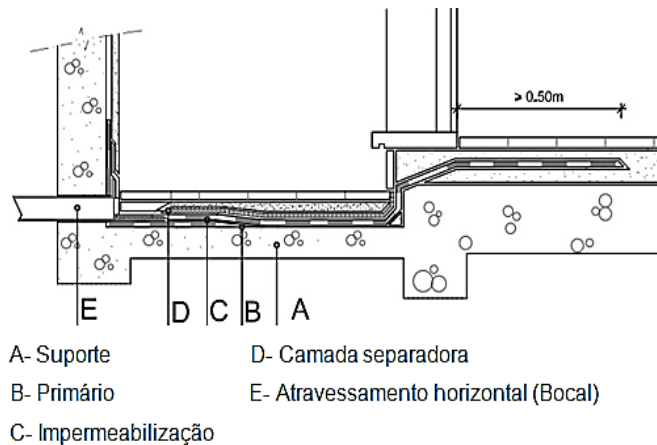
Pormenor de soleira (adaptado de Imperialum, 2014)
